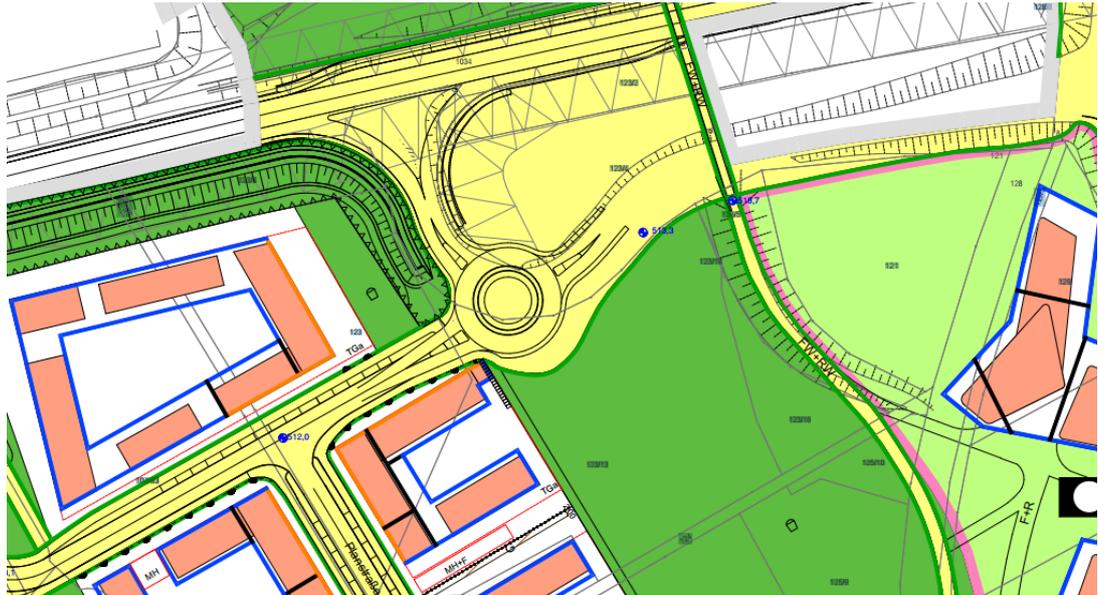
Planstraße vom Neubaugebiet zur Auf-/ Abfahrtsrampe mit Kreisverkehrsplatz
